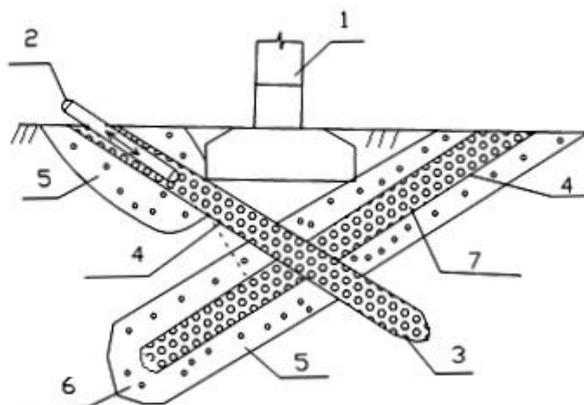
Схема усиления основания под существующим фундаментом сваями, устроенные с помощью пневмопробойников:
